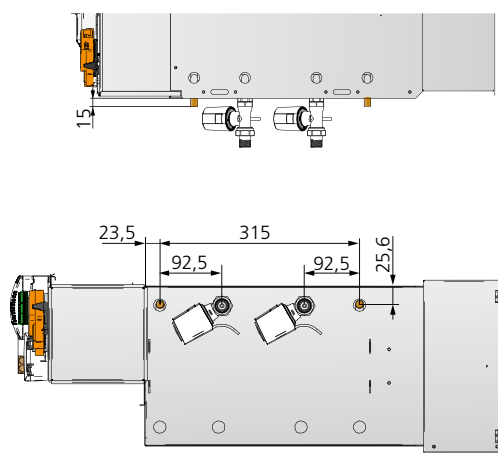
Schéma de dimensionnement, raccordement hydraulique
